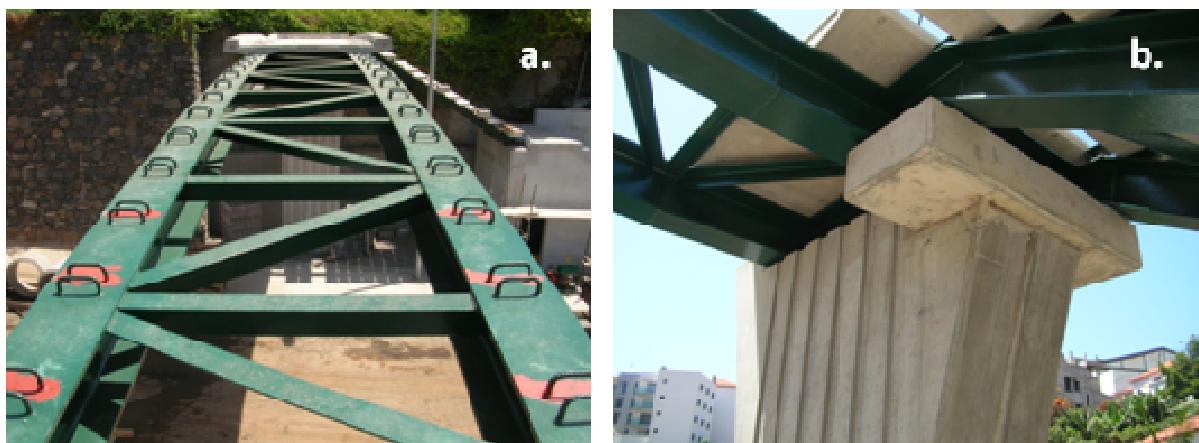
Montagem das lajes pré-fabricadas: a. Vista Superior da estrutura metálica; b. Vista inferior sobre o pilar
